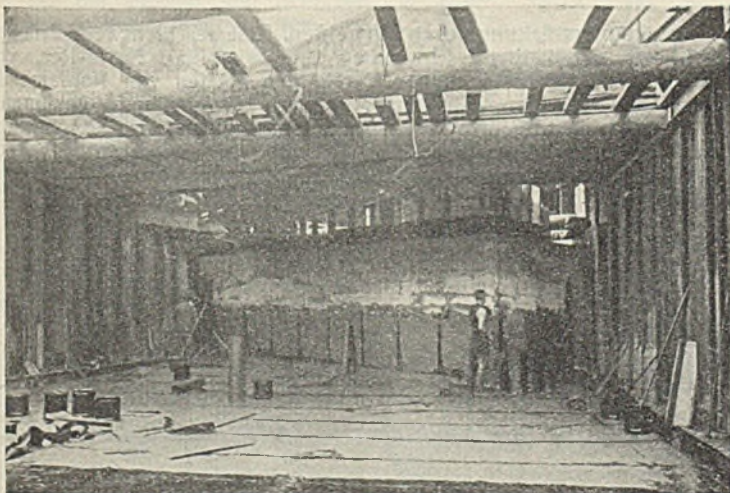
Deckendichtung des Untergrundbahntunnels unter dem Landwehrkanal an der Cottbuser Brücke in Berlin.
